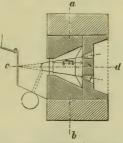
Grundriß nach gh. Doppel=Schachtofen.
